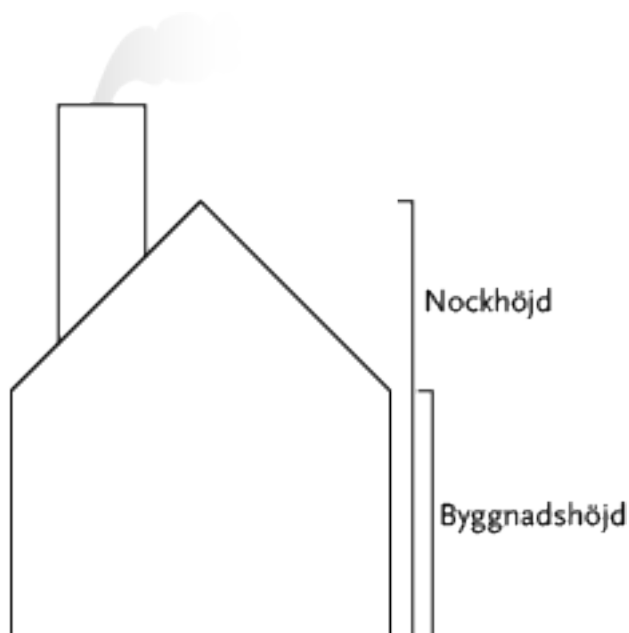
visar skillnaden på planbestämmelserna nockhöjd och byggnadshöjd.
